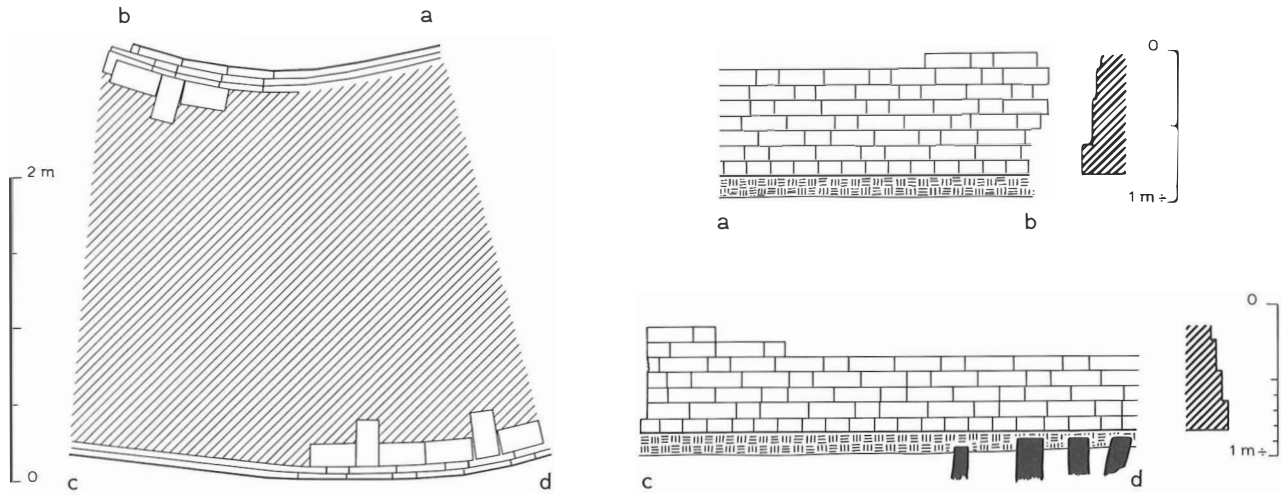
St. Bernardusabdij Aduard. Hochchorschluss, Mittelteil. Grundriss und Ansichten.
